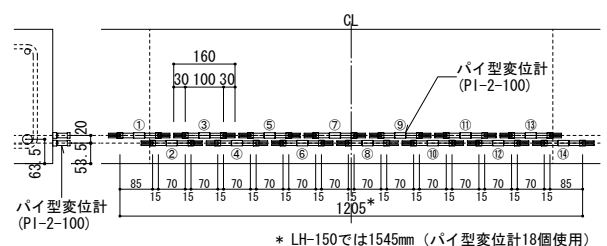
ひび割れ幅測定用パイ型変位計配置
